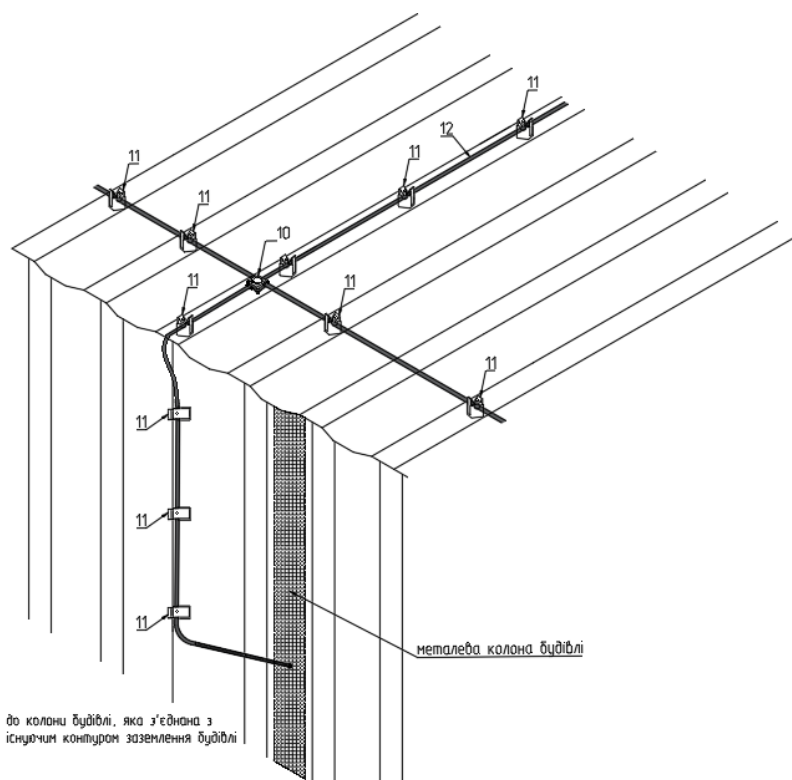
Спуск заземлення по зовнішній стіні будівлі
